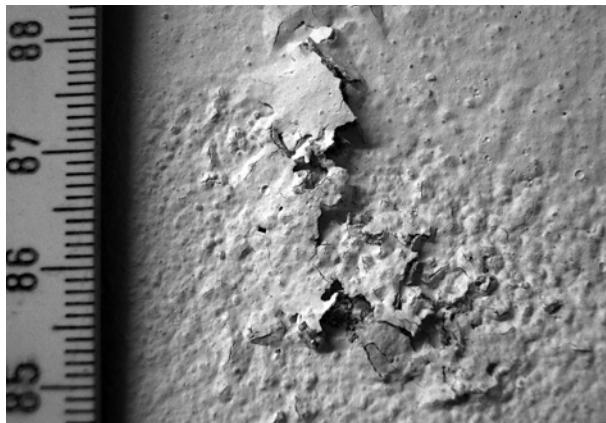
■ Salze drücken den Anstrich vom Untergrund ab
